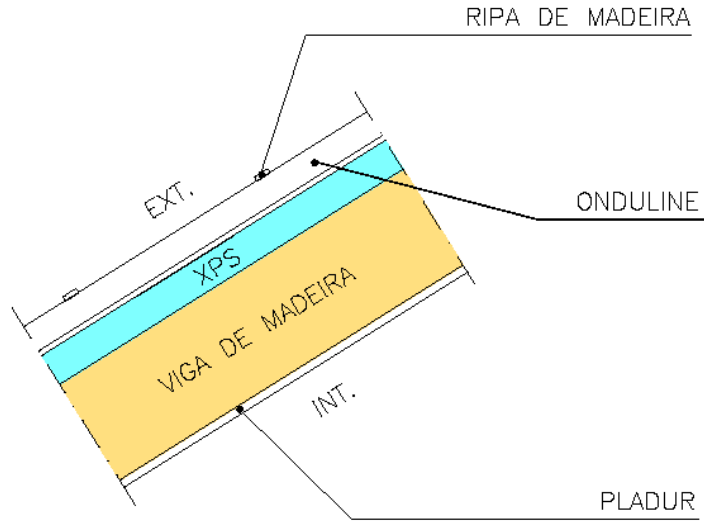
Vigamento da cobertura e respectivo isolamento térmico.
